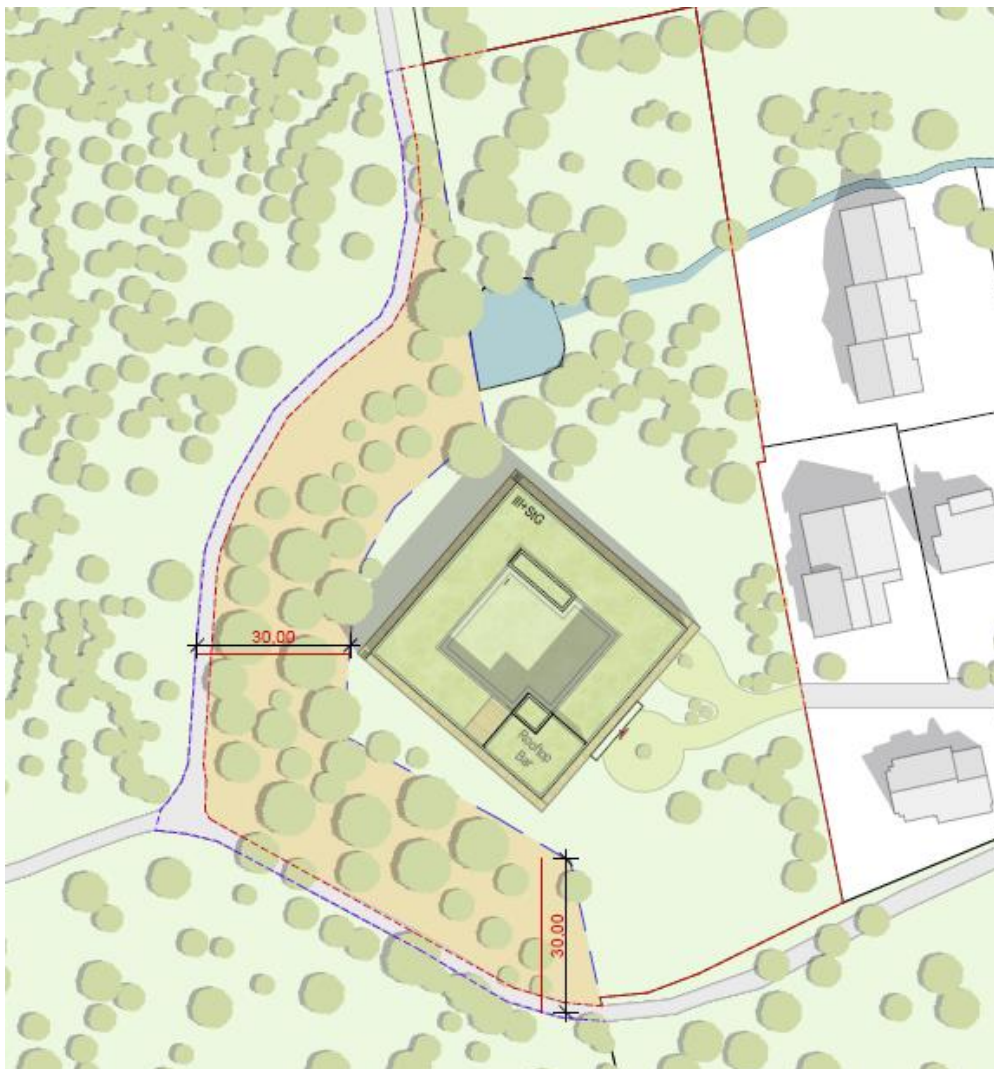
Hotelneubau. Bilder zur Verfügung gestellt durch MPP - Meding Plan + Projekt GmbH.
